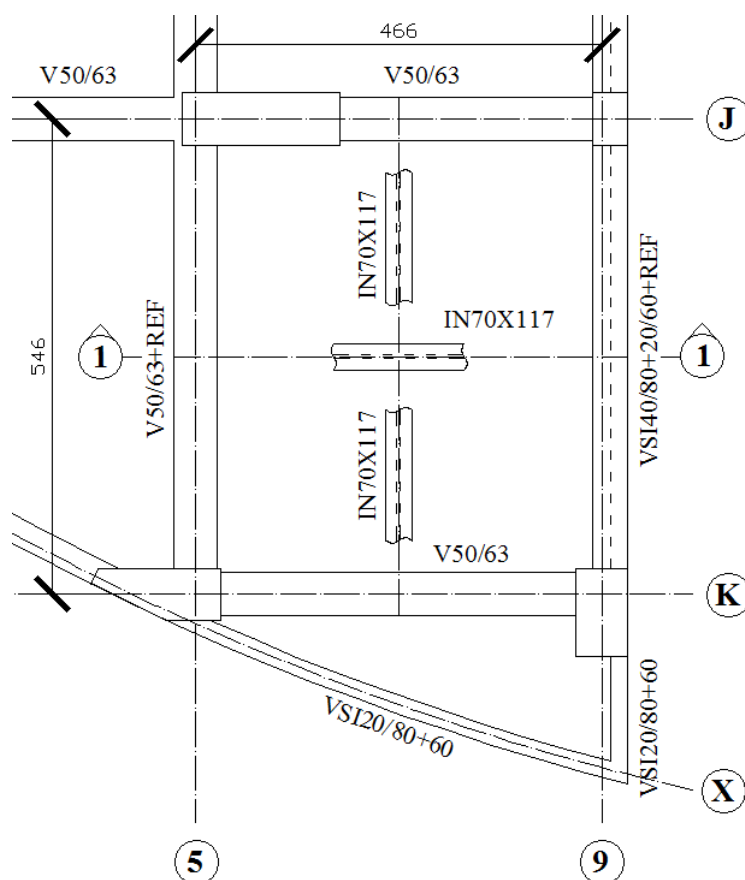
refuerzo de losa de azotea en sector donde se ha dispuesto del AMS.
